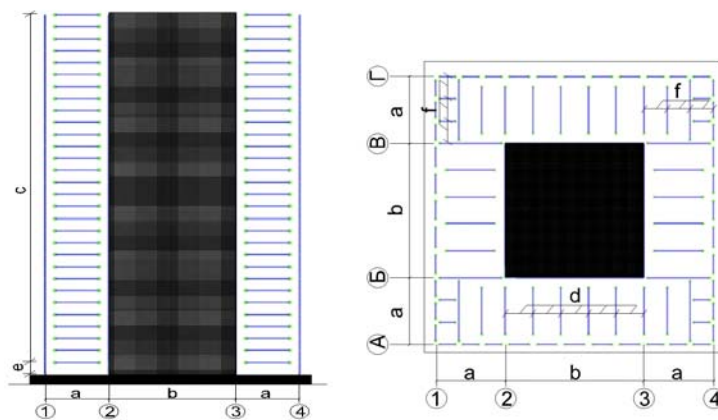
План та центральний розріз конструкційної системи будівлі:
